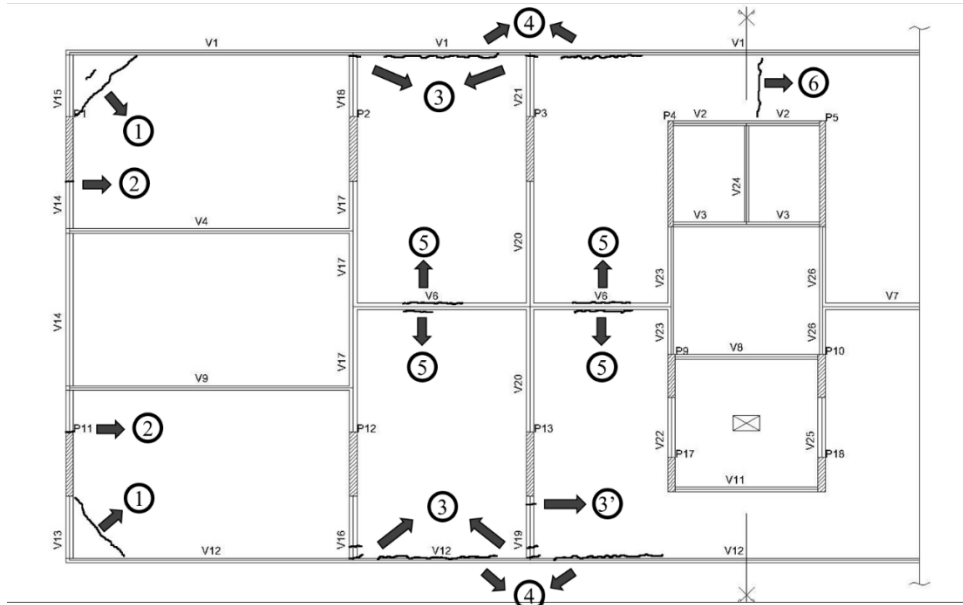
Dia 08: situação das fissuras relatadas e aparecimento de novas fissuras. Fonte: adaptado de Fusco (1996).
